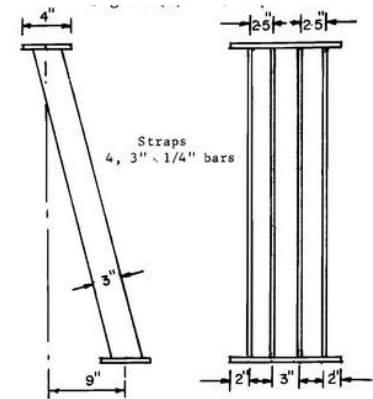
Detalle de tirante inclinado ensayado por Menon y Furlong [37]
